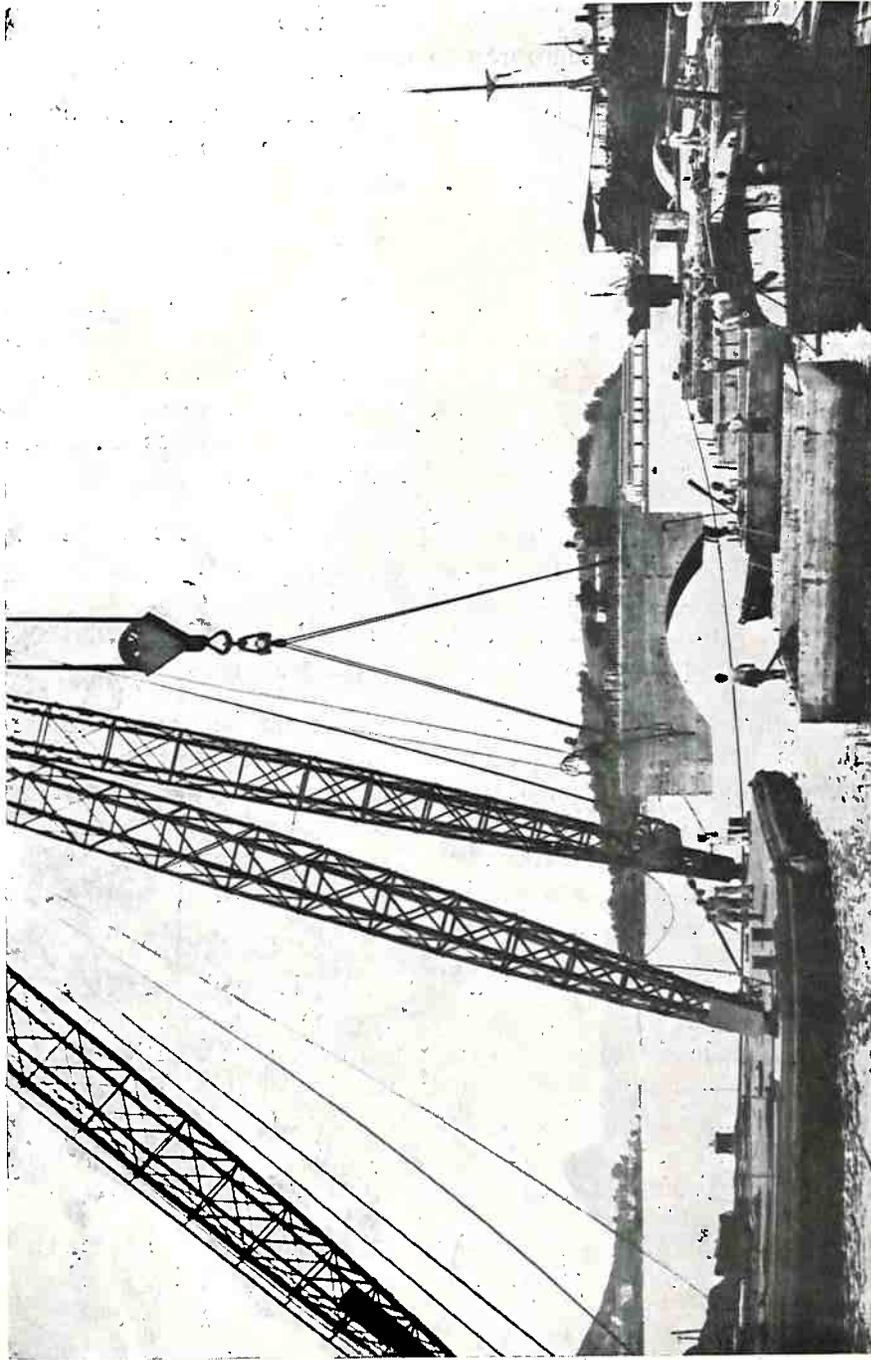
Montagem de uma arcada no cais da Ilha Viana -- R. de Janeiro.
